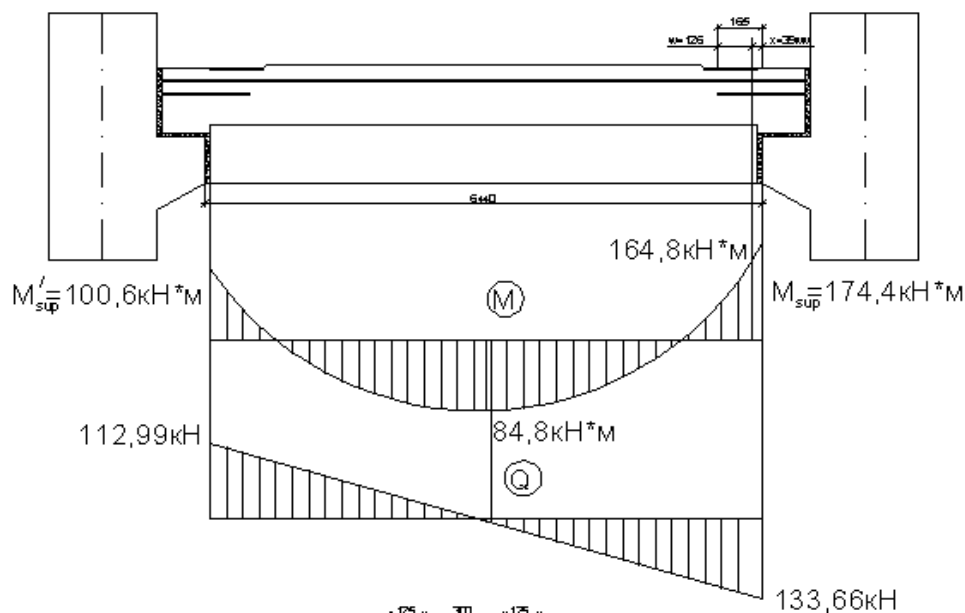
Ригель многоэтажной рамы с эпюрами изгибающих моментов и поперечных сил от распределенной нагрузки
